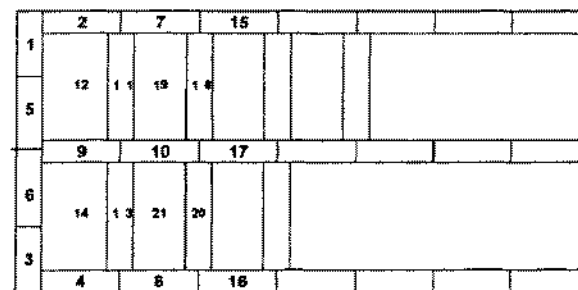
Схема монтажа элементов с приобъектного склада
